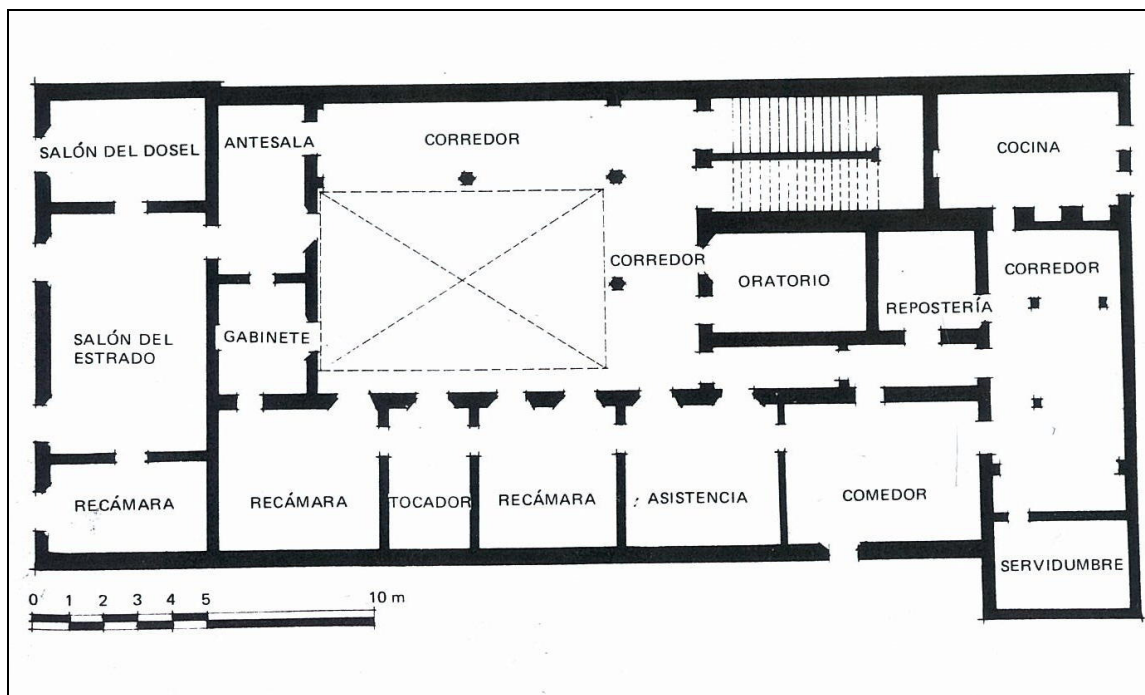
Casa del conde de Xala, planta (*Vocabulario arquitectónico ilustrado*, p. 109)
